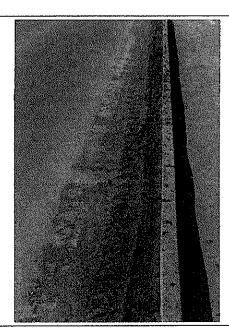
Alcantarilla sin su sección libre en un 90%, kilómetro 42, camino rol G-16. (09-08-2013)
